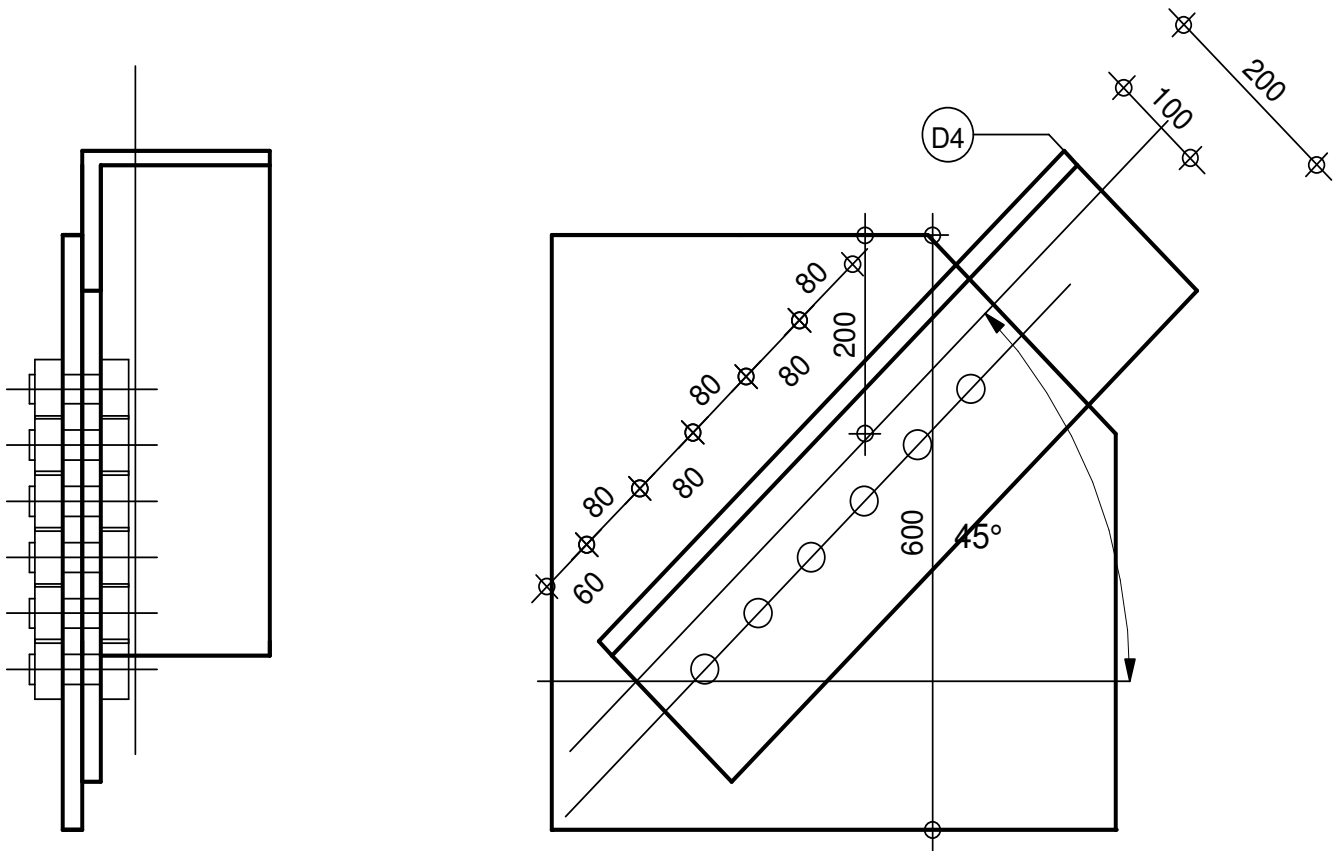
Plan d'exécution de l'assemblage. Cotes en mm.
